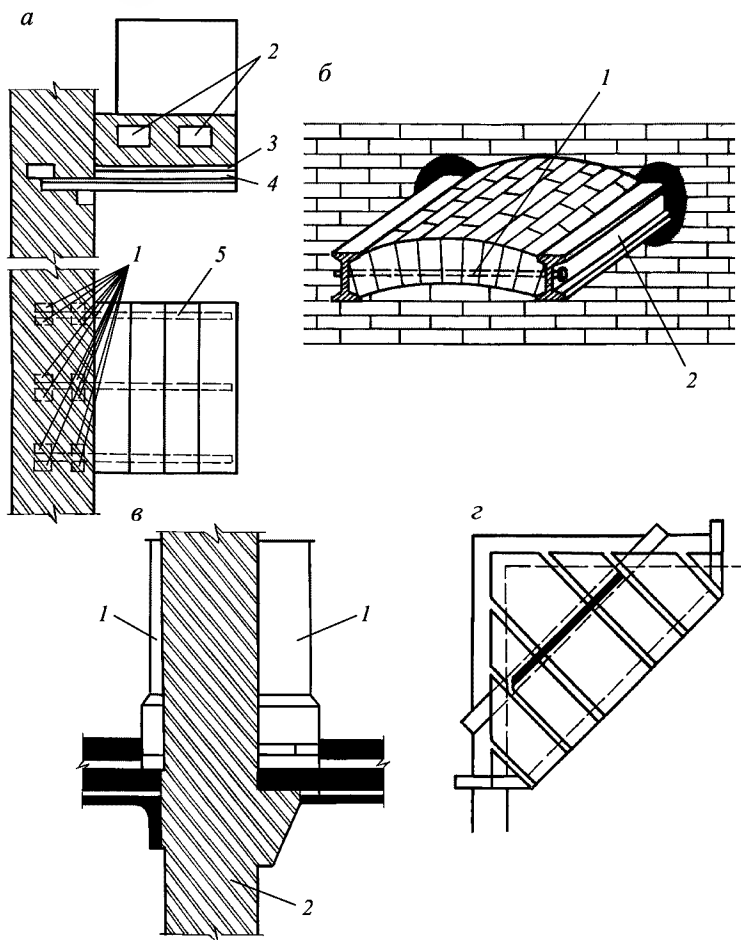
Основания под печи верхнего этажа в каменных зданиях:
